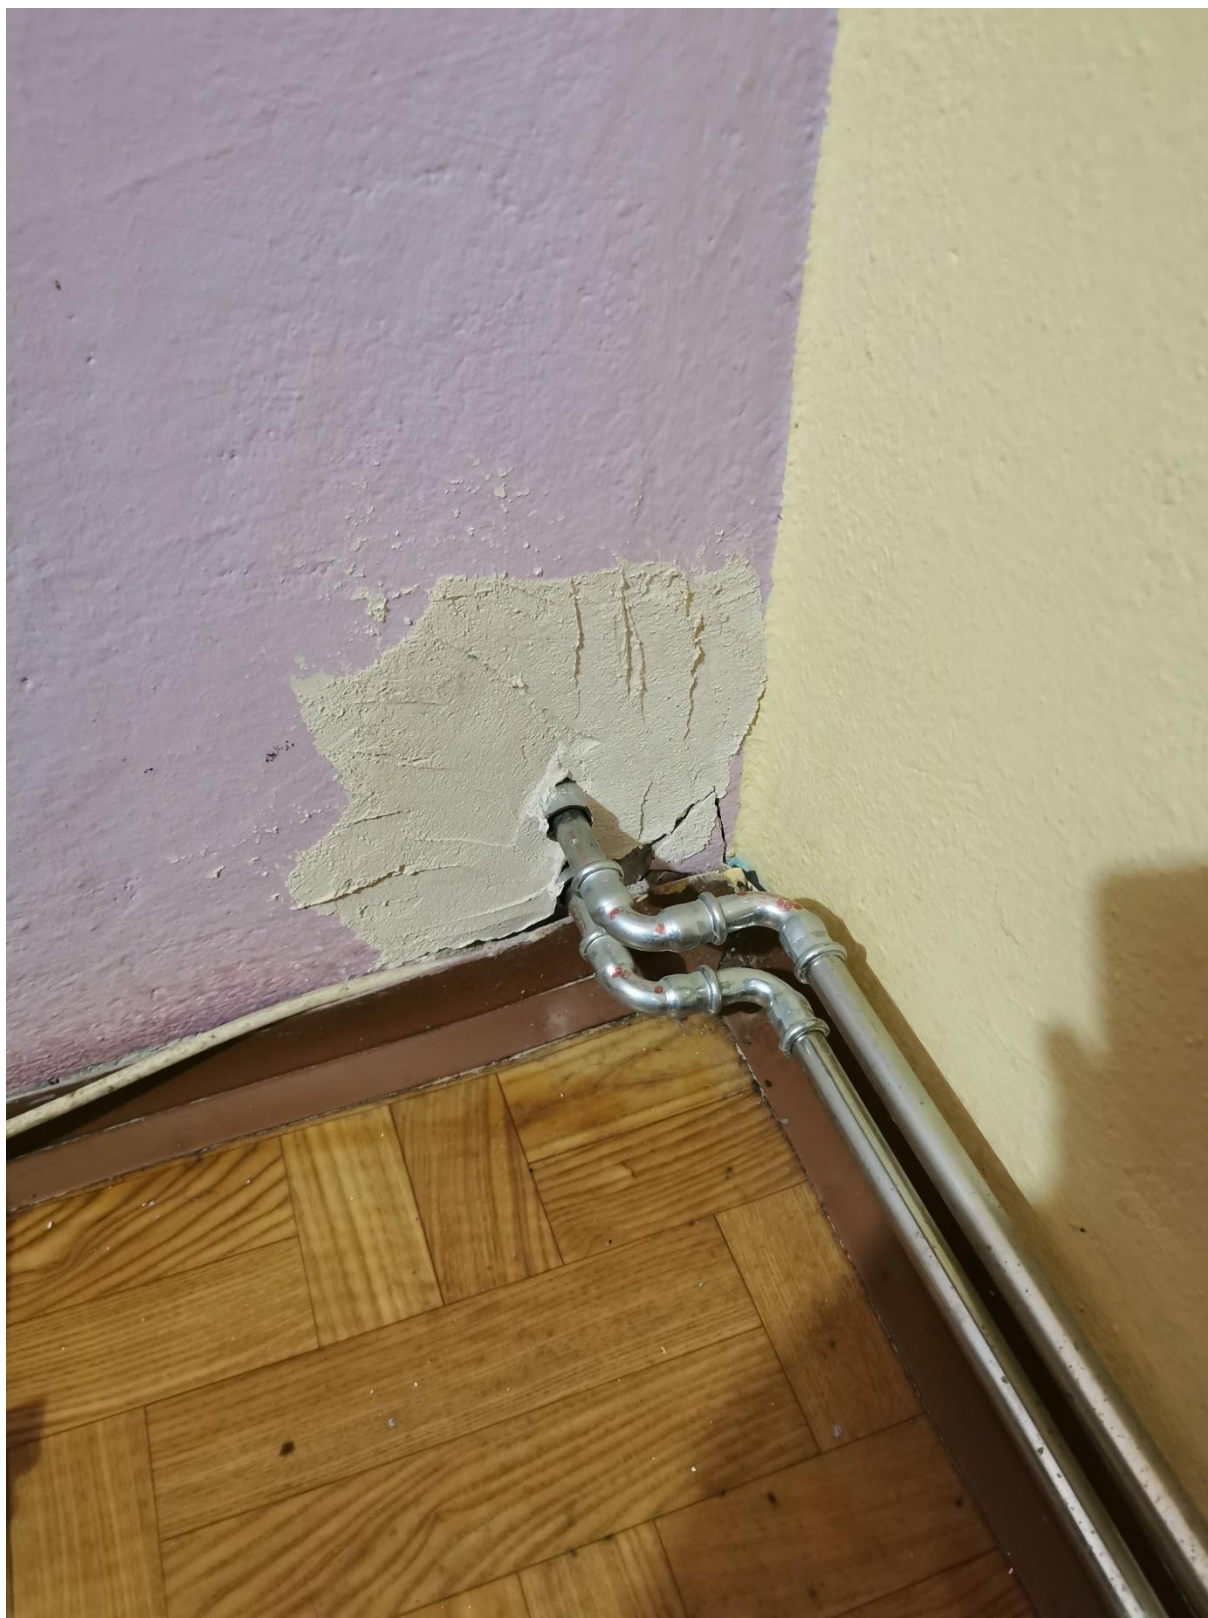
1.40B – brak odtworzenia do stanu pierwotnego (glazura)
